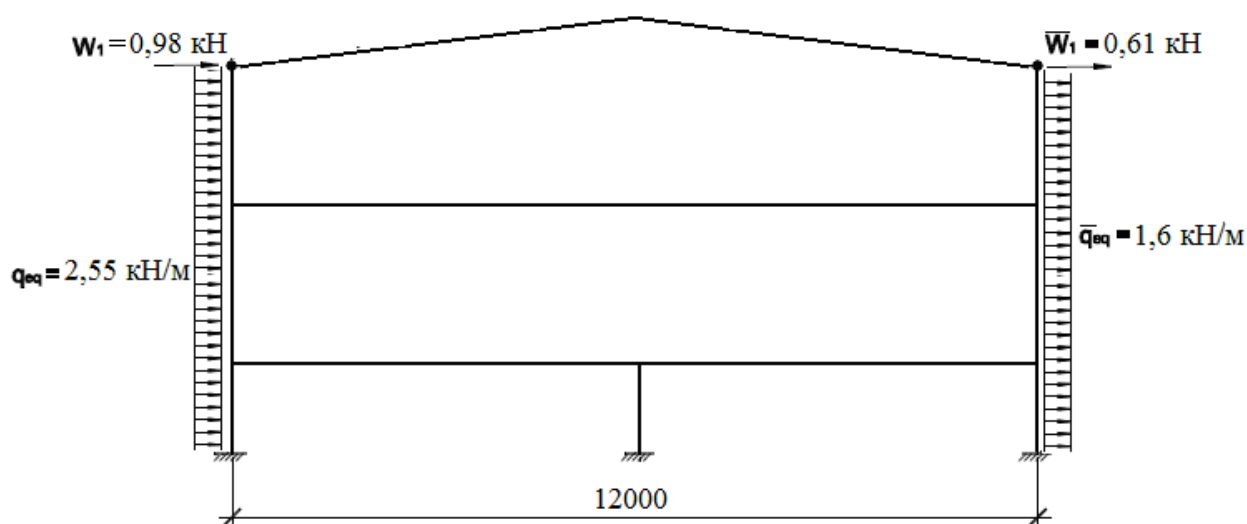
Схема загрузки от ветровой нагрузки слева здания
